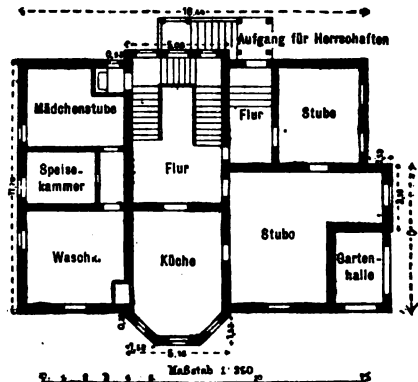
Grundriß des Untergeschoßes einer Villa.
